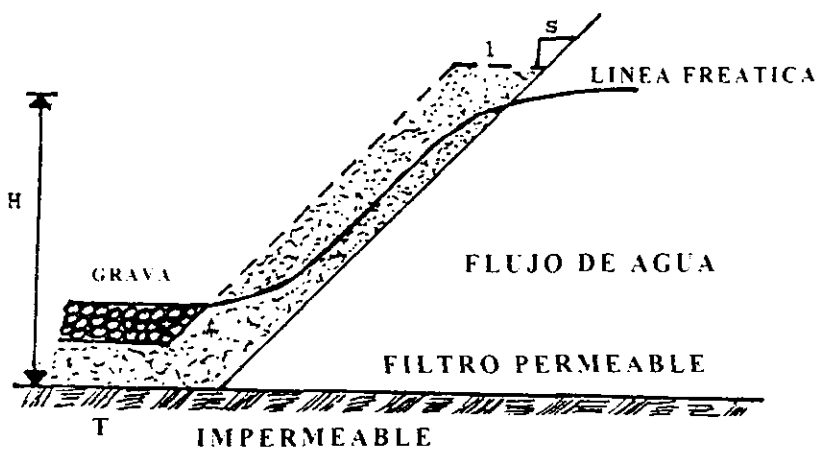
PROYECTO DE FILTROS (SEGUN CADERGREN, 1960)
